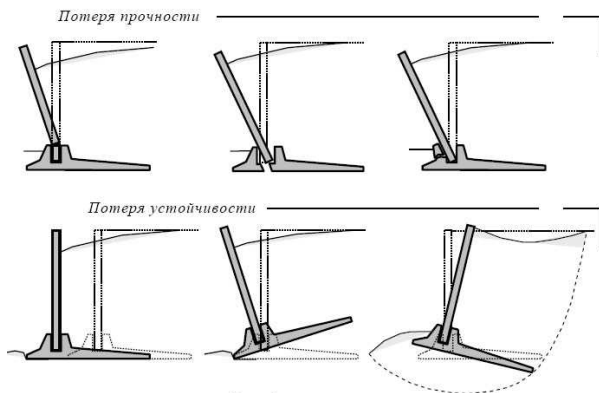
Вероятные пути разрушения подпорной стенки из плит ПФ и ПЛ
